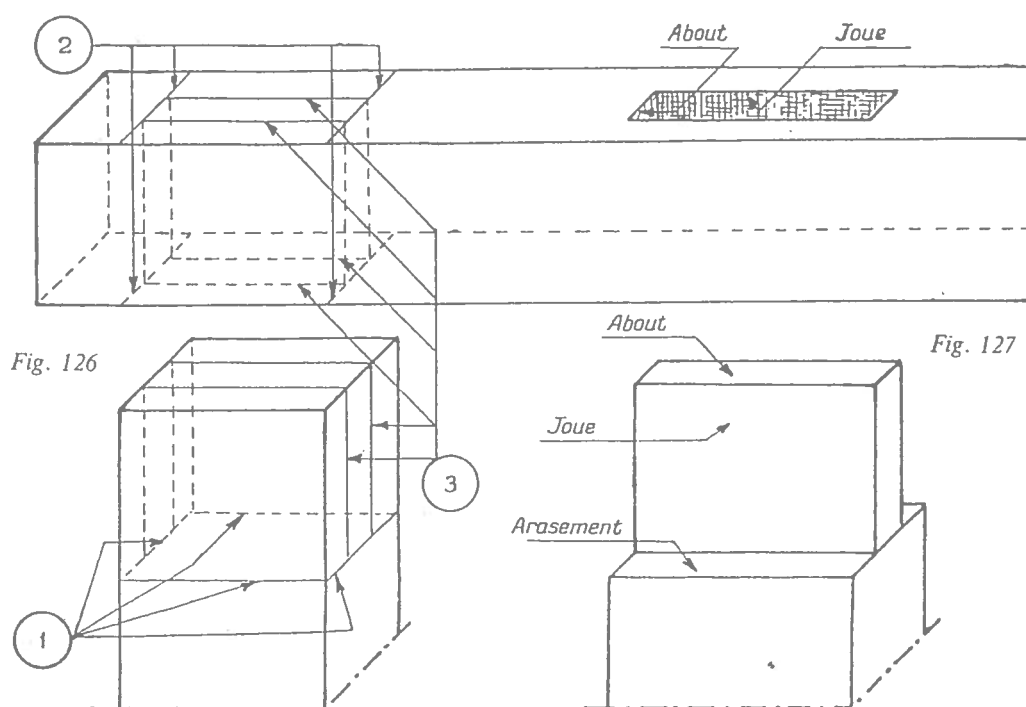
Tracé d'un assemblage à tenon et mortaise :
